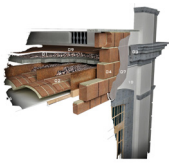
, detalle del sistema de entrespiso de Orizaba 146 a base de un entramado de vigas de madera. Imagen realizada por el autor, 2008.
